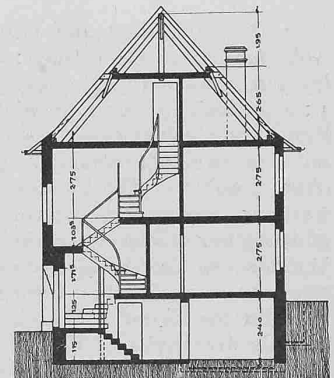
bis 12. Grundrisse und Schnitt Typ III. — 2 Einfamilienhäuser zu je 5 Zimmern. — 1 : 250.
